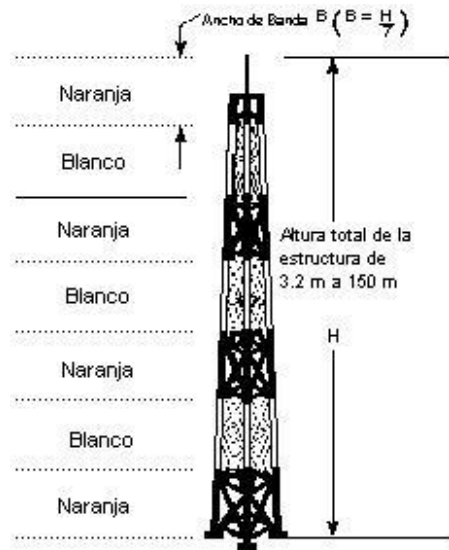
(Pintura de la torre) Bandas Alternas.
